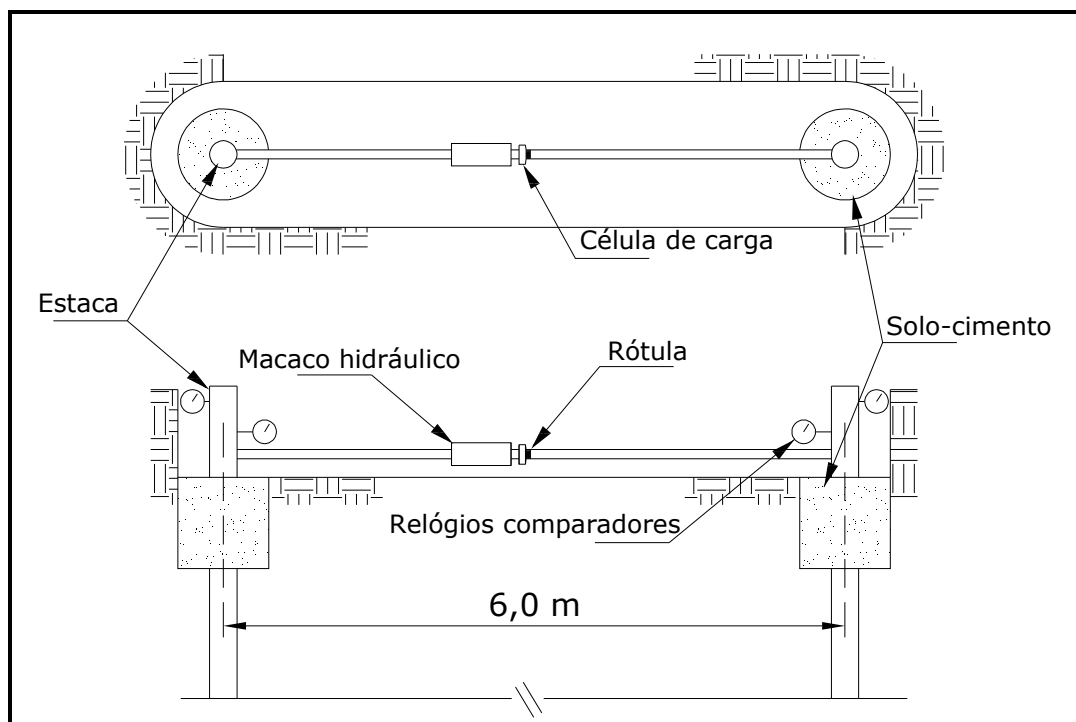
Esquemática do ensaio de carregamento horizontal.
